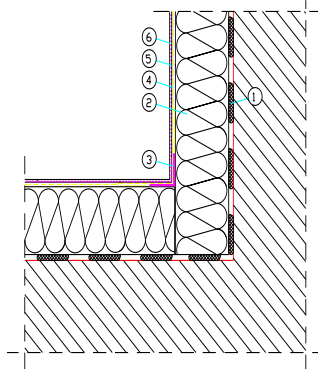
Docieplenie muru powyżej połaci dachu.
